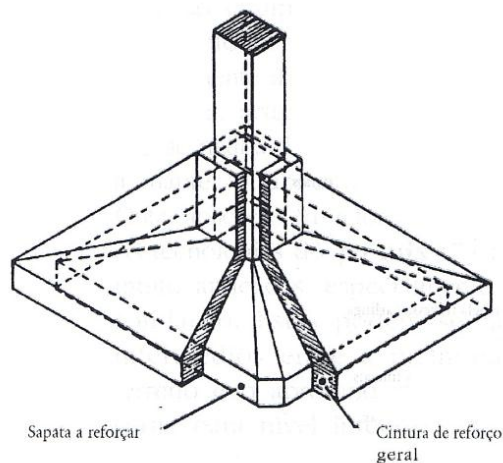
REFORÇO DE SAPATA DE BETÃO ARMADO POR CINTURAGEM DE BETÃO ARMADO [4].
